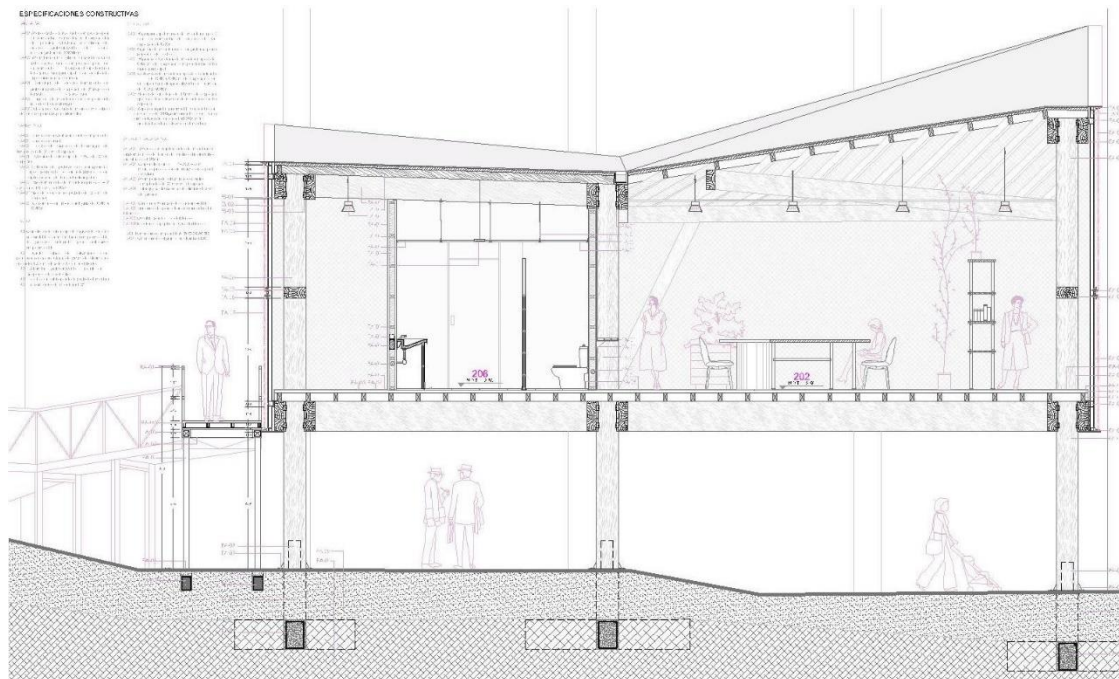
Corte constructivo del centro agrónomo. Fuente Propia.
